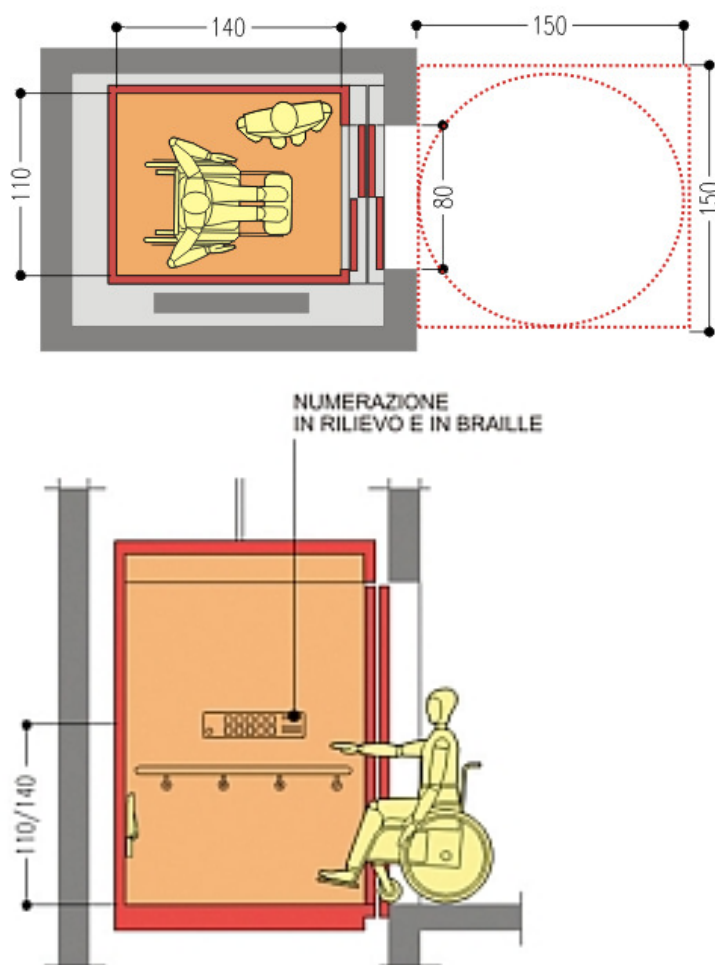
Schema tipo in pianta e in sezione di ascensore per disabili
